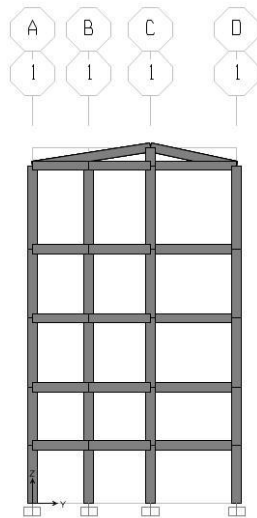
Elementos estructurales en el cuadrante “yz” sobre el eje “1”.
